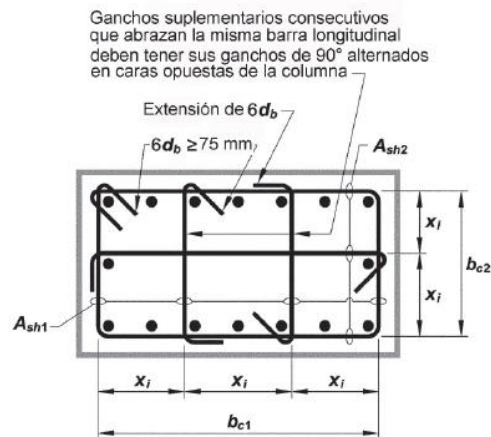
Ejemplo de refuerzo transversal en columnas
